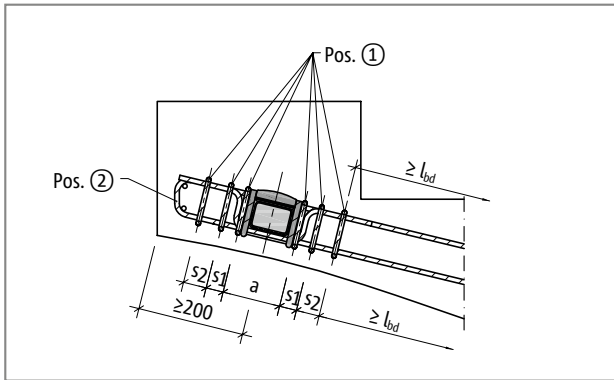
Schöck Tronsole® tipo Q, Vista "punto testa"
